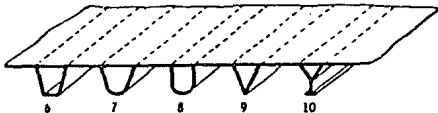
VIGAS DE CONCRETO REFORZADO Y PRESFORZADO.
